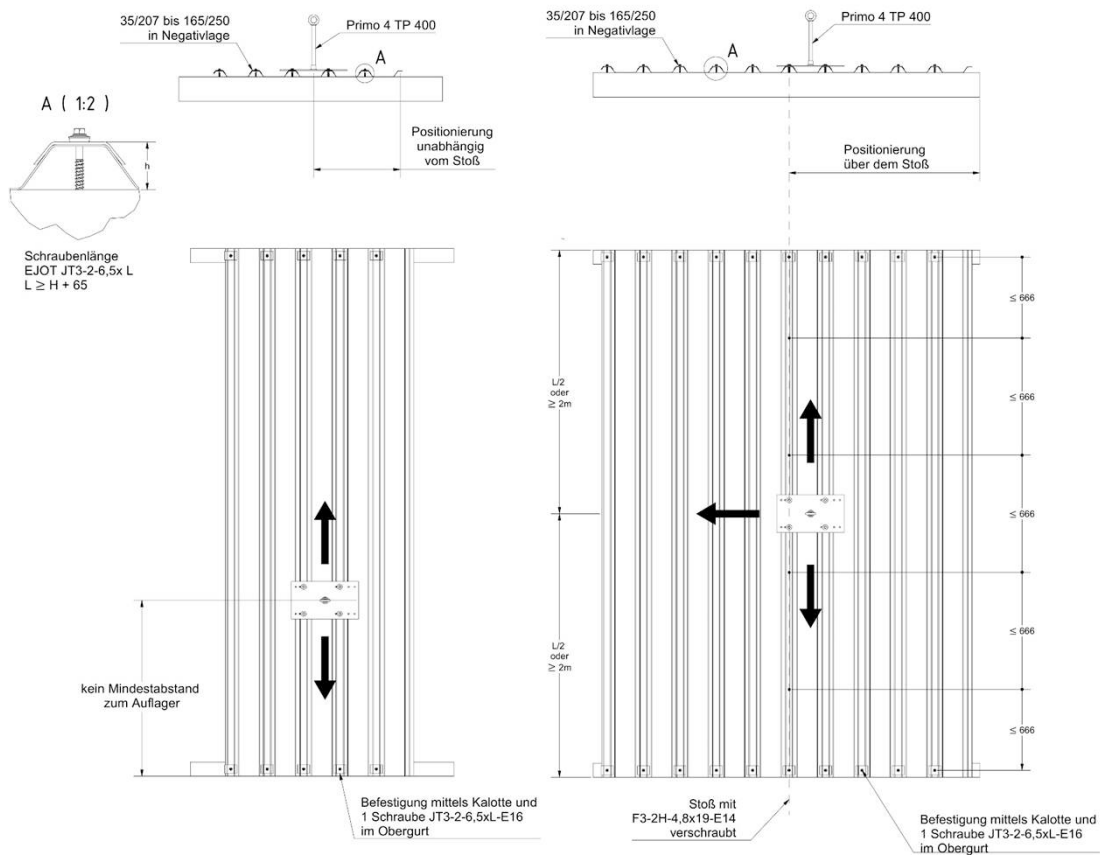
Primo 4 TP, Variante A-2: Negativlage, Befestigung mit einer Schraube mit Kalotte, Profilhöhen 35 bis 165mm, Blechdicke 0,75mm
